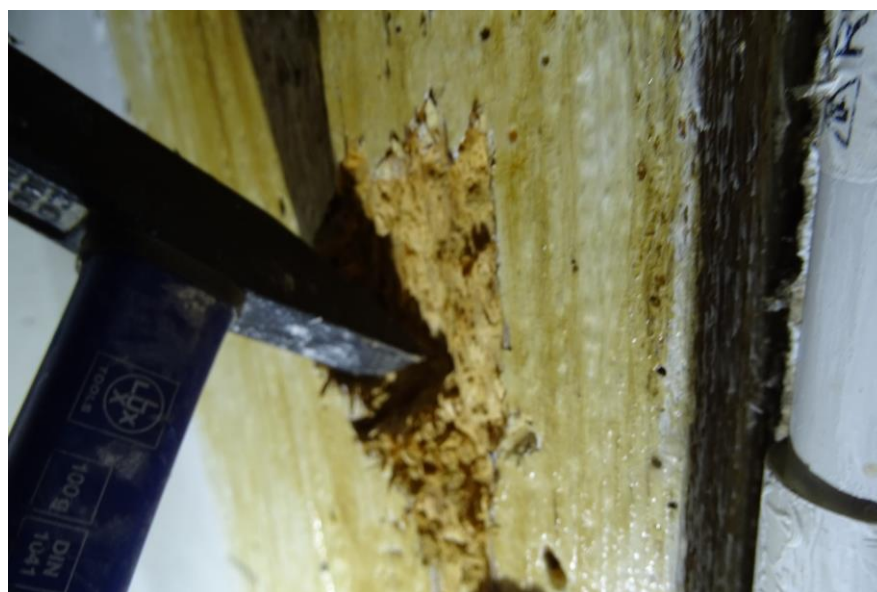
Otwory wylotowe ksylofagów na zastrzale drewnianym zabudowanym ścianą murowaną
